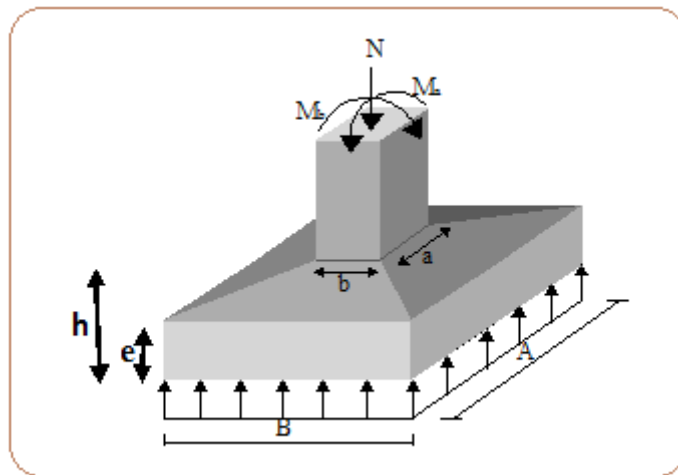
Représentation des semelles isolées sous poteaux carrés
